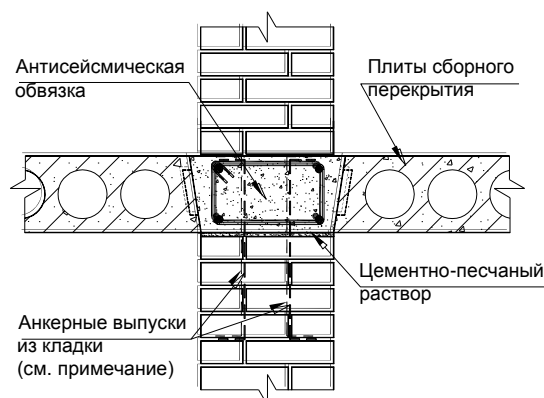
Примеры устройства железобетонных антисейсмических обвязок в уровнях междуэтажных сборных перекрытий
